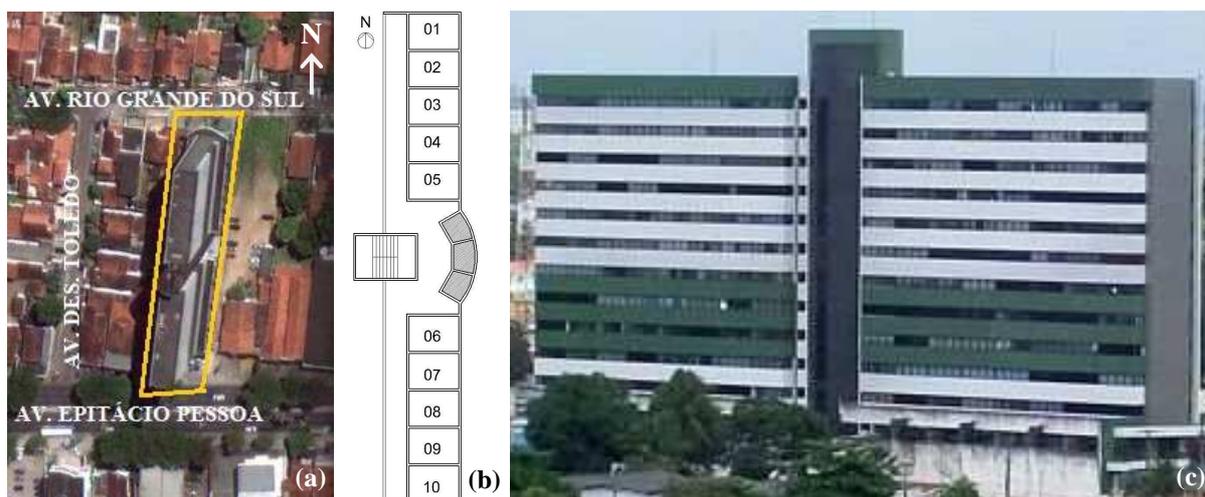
Central Park: imagem aérea (a) (GOOGLE EARTH, 2011), croqui da planta baixa do pavimento tipo (b) e vista nordeste (c) (SKYSCRAPERCITY, 2008).
